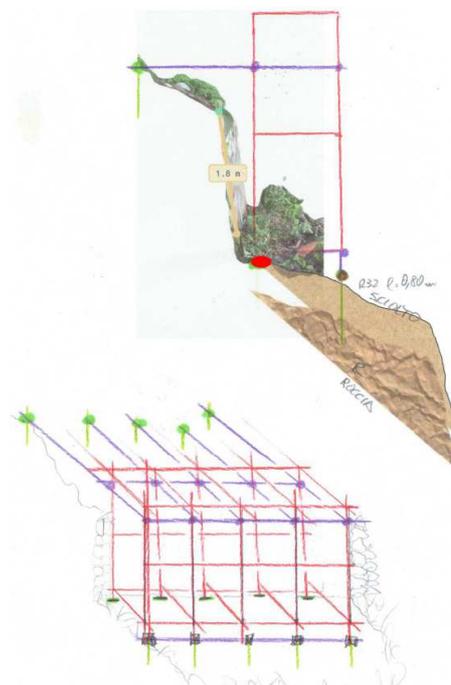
Sezione tipo con ponteggio di tipo B
